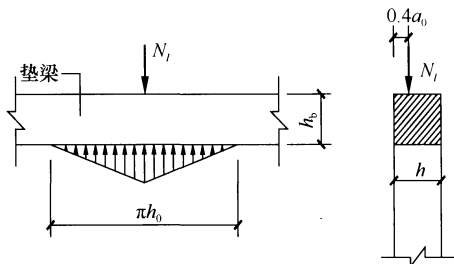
混凝土板或梁下设有混凝土垫梁
